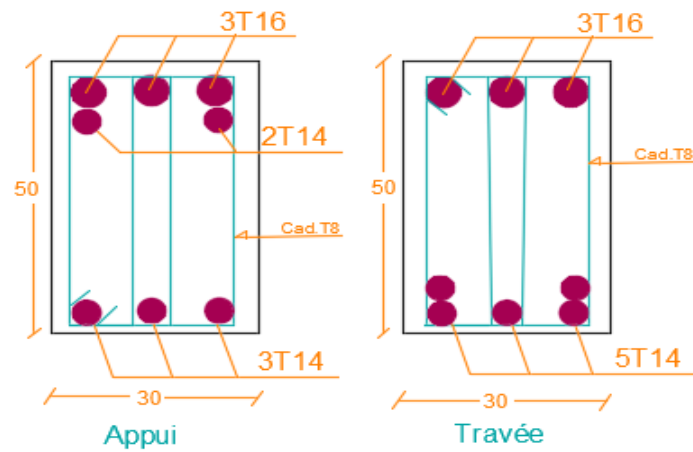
Ferrailage Des Poutres Porteuses Axes (C-D) Du Niveau Terrasse.
